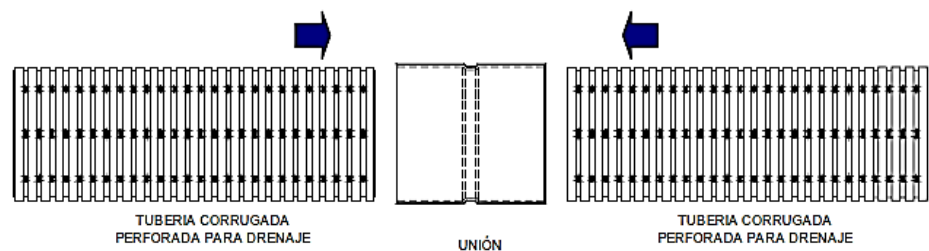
Alternativa 2: Tubería perforada para sub drenes tipo francés.
